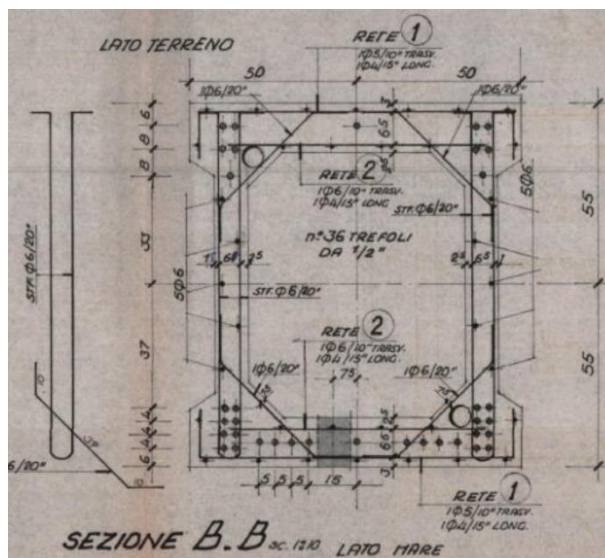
Sezione trasversale diaframma in c.a.p. (dal progetto originario del 1977)
